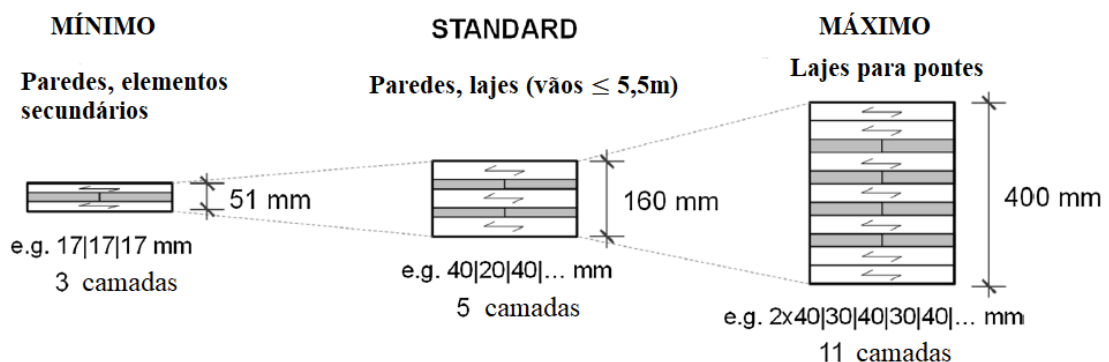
Aplicações do CLT: Espessuras segundo sua aplicação. Adaptado de Schickhofer (2015)
